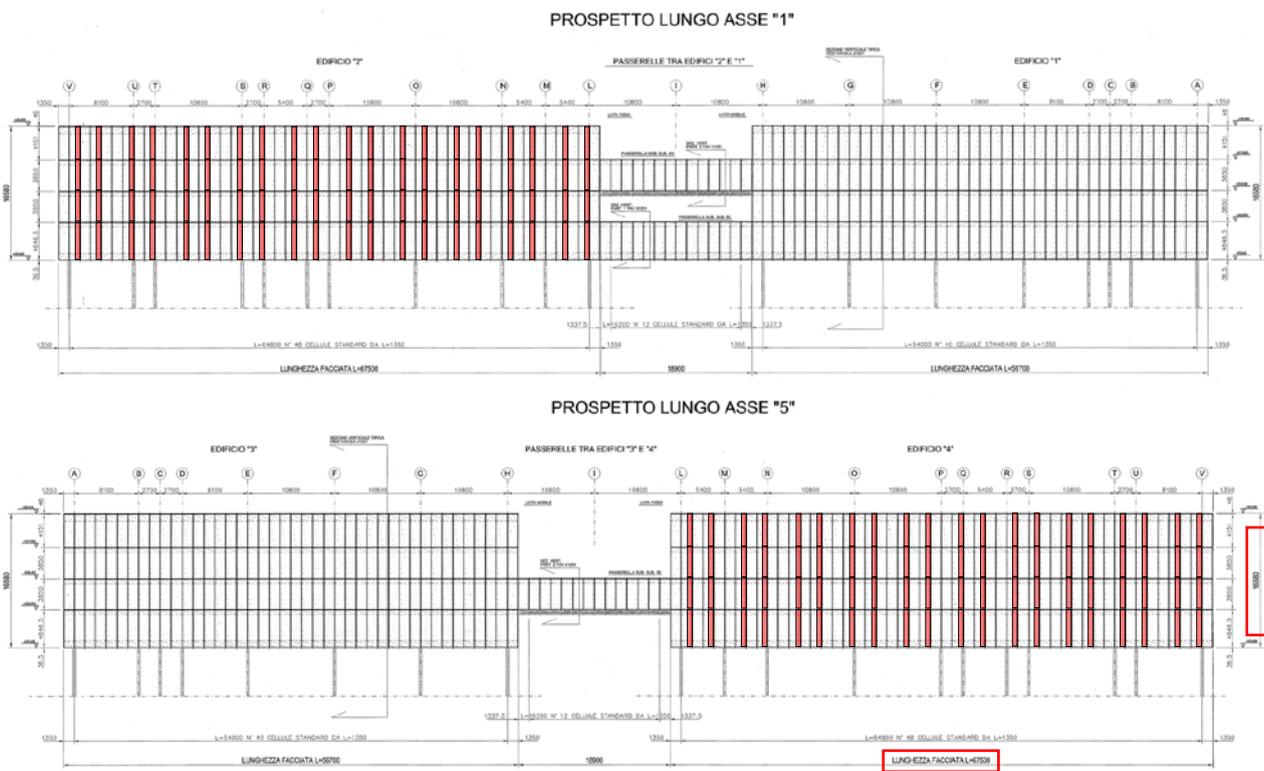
prospetto con esempio di distribuzione delle nuove aperture –
